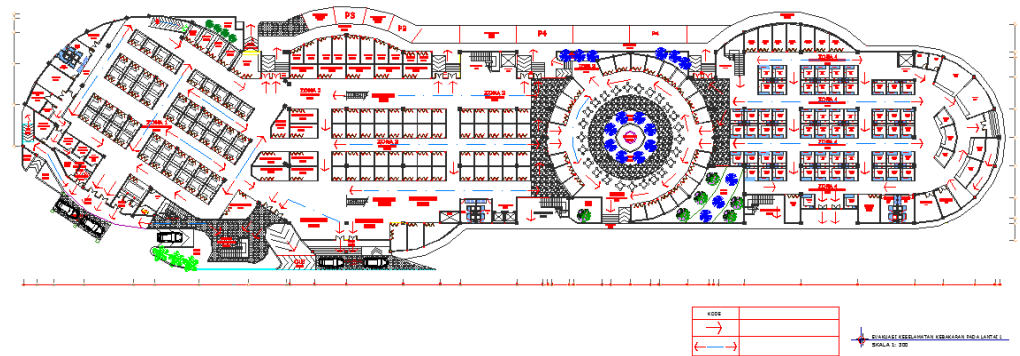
Evakuasi kebakaran pada Layout Plan
